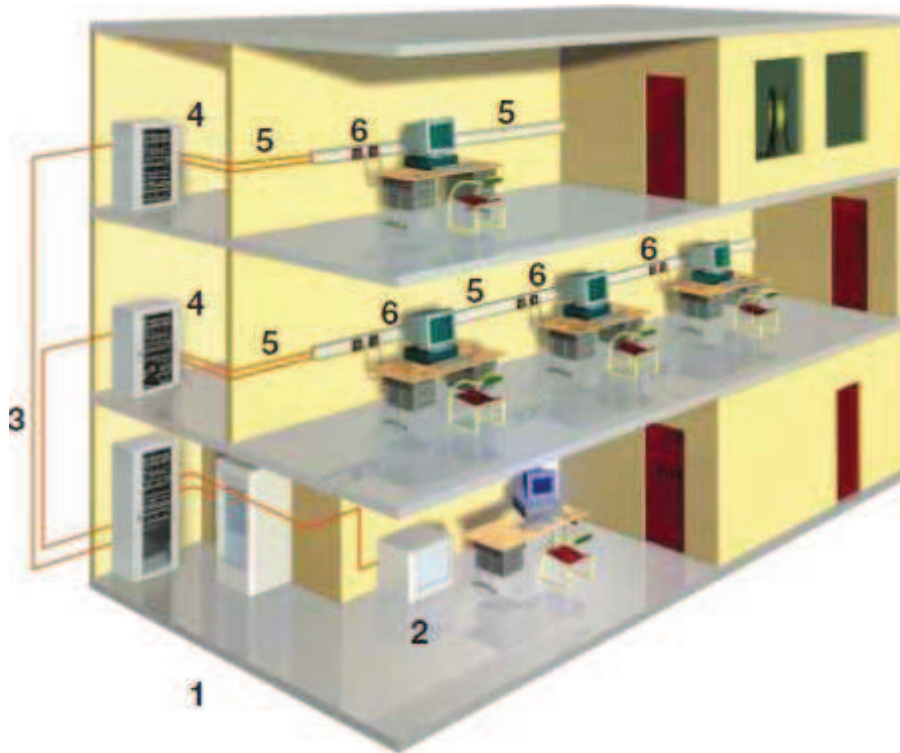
Infraestructura de un Cableado Estructurado. [35]
